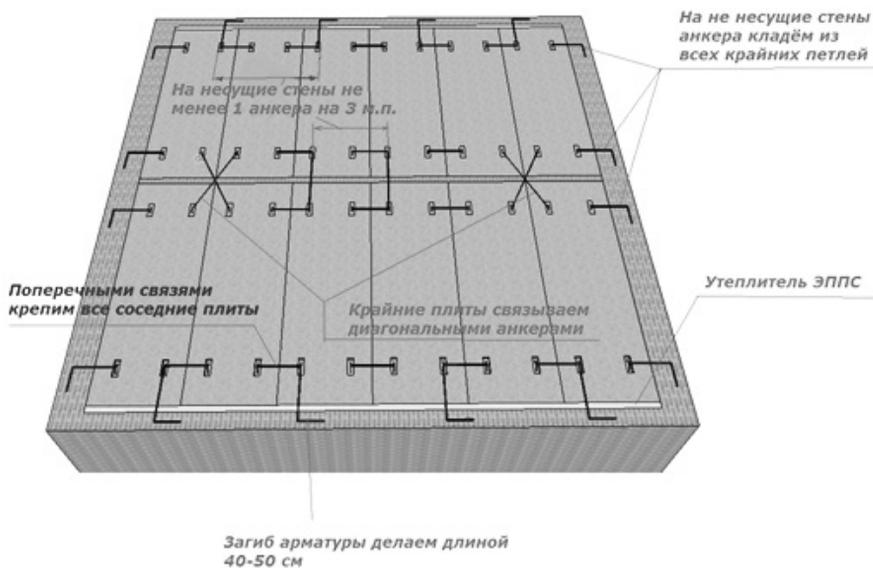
Правильная анкеровка сборных ж/б плит перекрытия этажа анкерными стержнями диаметром 10 мм.
